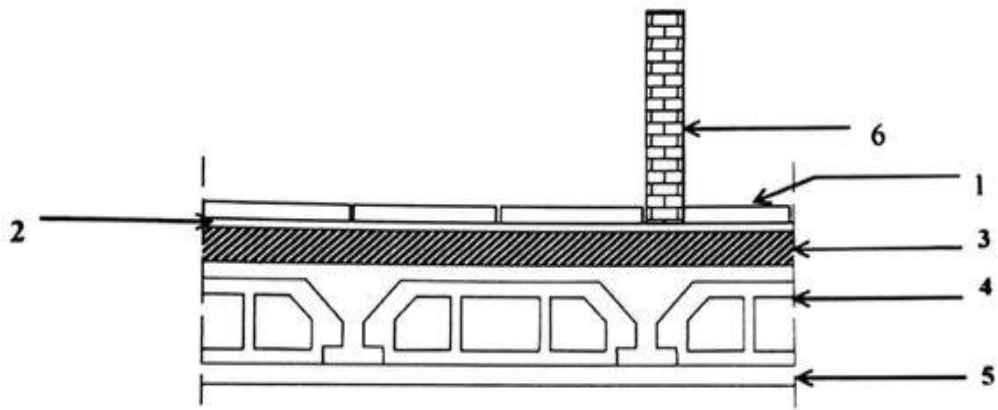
Coupe verticale du plancher courant à corps creux.
